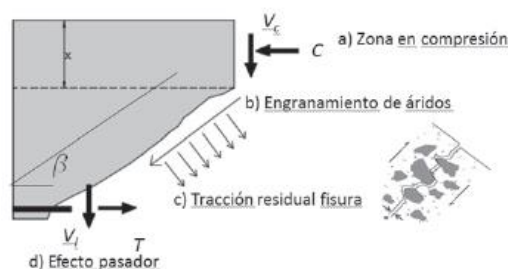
Mecanismos de transferencia de cortante en una viga de hormigón armado sin refuerzo transversal [4]
